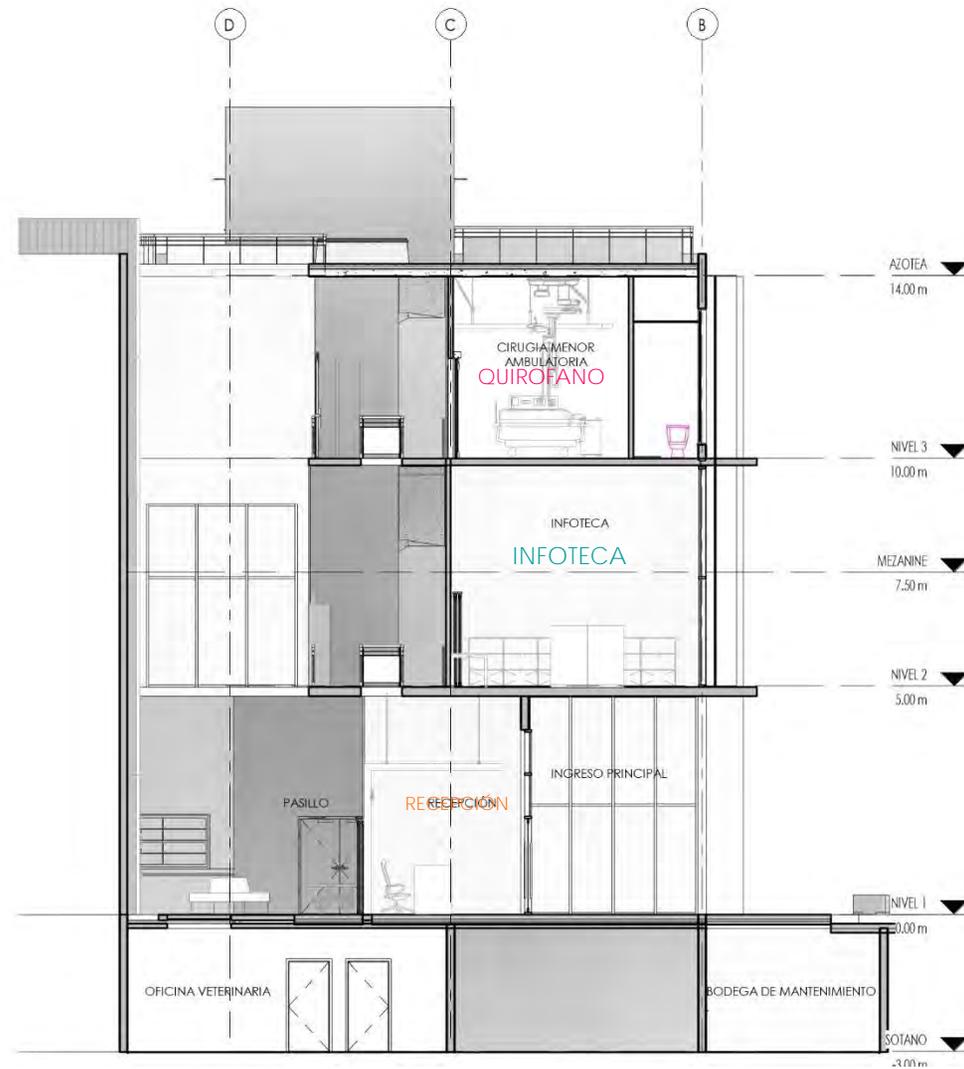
Corte transversal 2-2. Elaboración propia, 2020.
